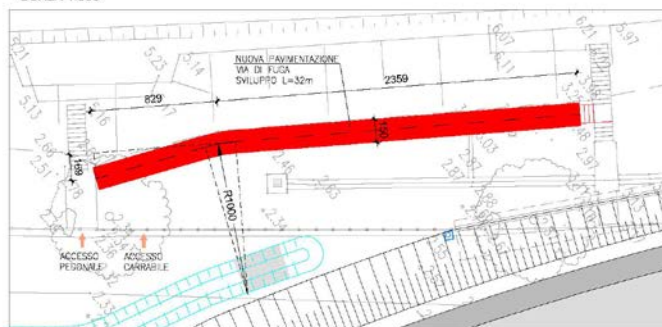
Scale di sicurezza – Zona sud ponte Marzenego
